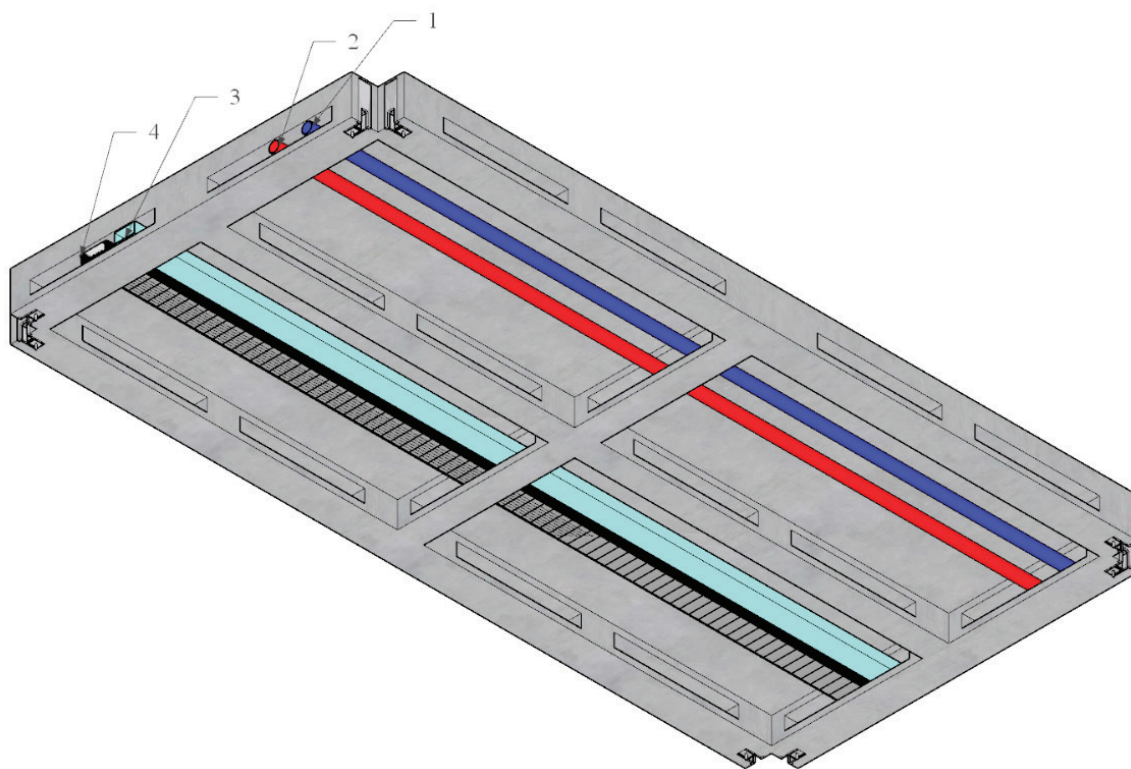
Пример установки инженерных коммуникаций в плите перекрытия (1 — холодное водоснабжение, 2 — горячее водоснабжение, 3 — вентиляционный канал, 4 — электрический кабель-канал)
